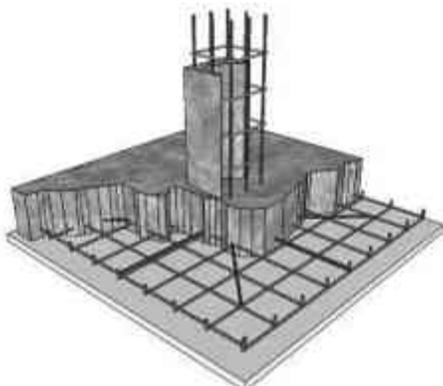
Es un elemento que funciona como un zapato o pie de estructura. El elemento sobresaliente se llama "dado" donde estarán colados los pernos (tornillos roscables) desde donde se soldará la columna metálica. Imagen editada por: Martín Rubio Avalos.
